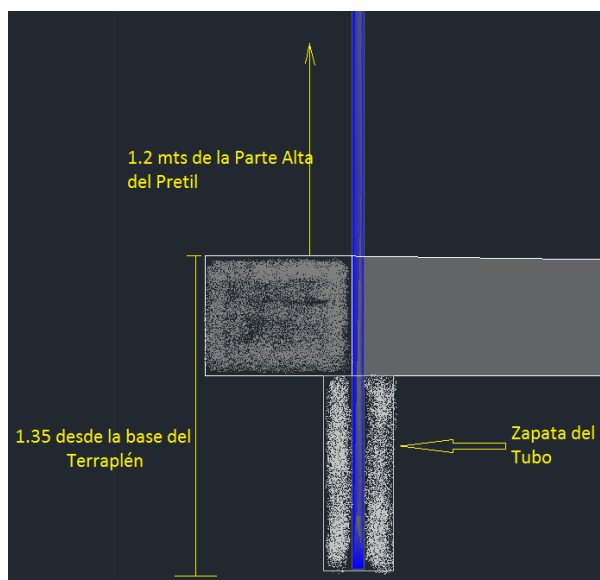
Corte del poste y la zapata para fijarlo.
